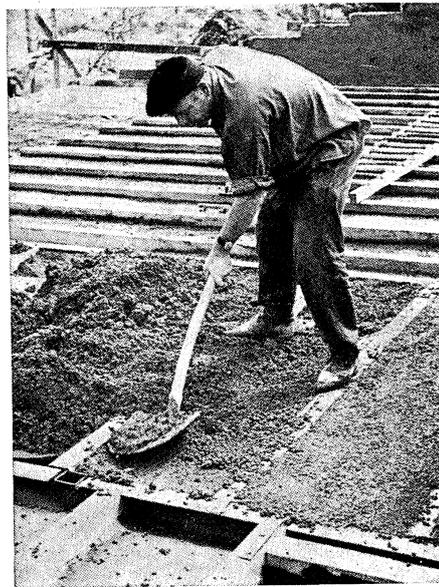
Relleno de los huecos entre las viguetas del techo.
